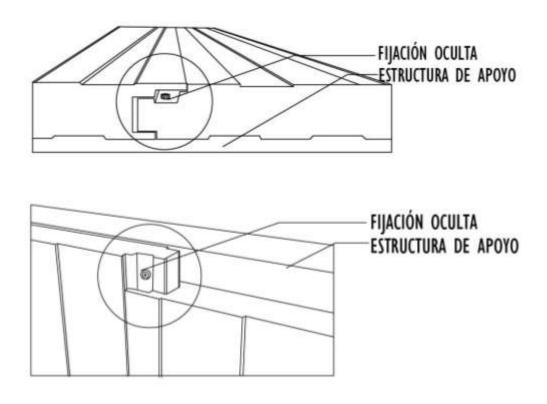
detalles constructivos Panel sándwich poliuretano
